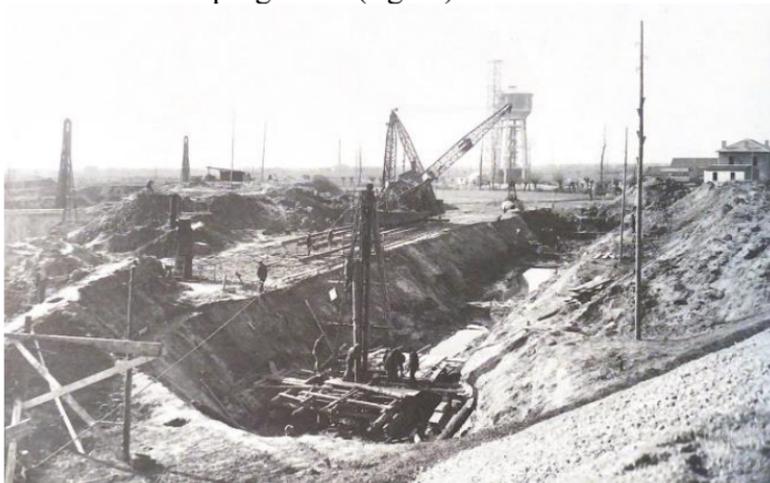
Lavori di escavazione del canale Boicelli e costruzione della Biconca di navigazione
